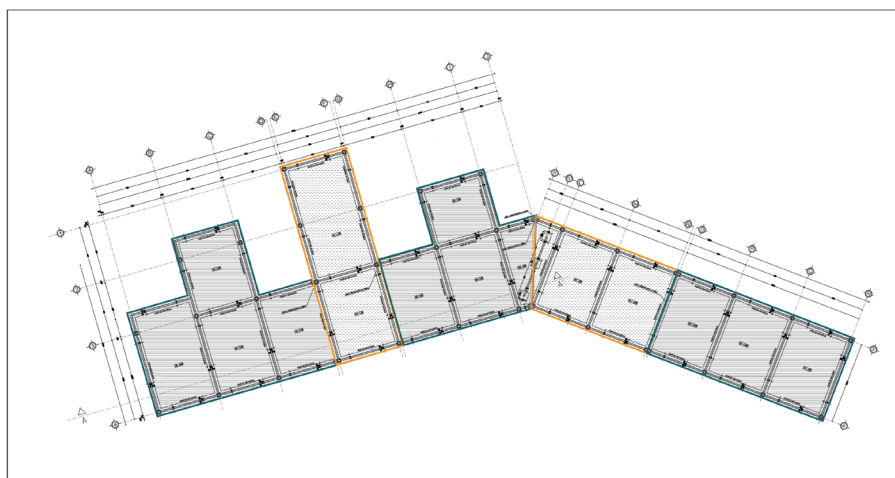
Planta de cimentación. Elaboración: (Pérez, 2018)
